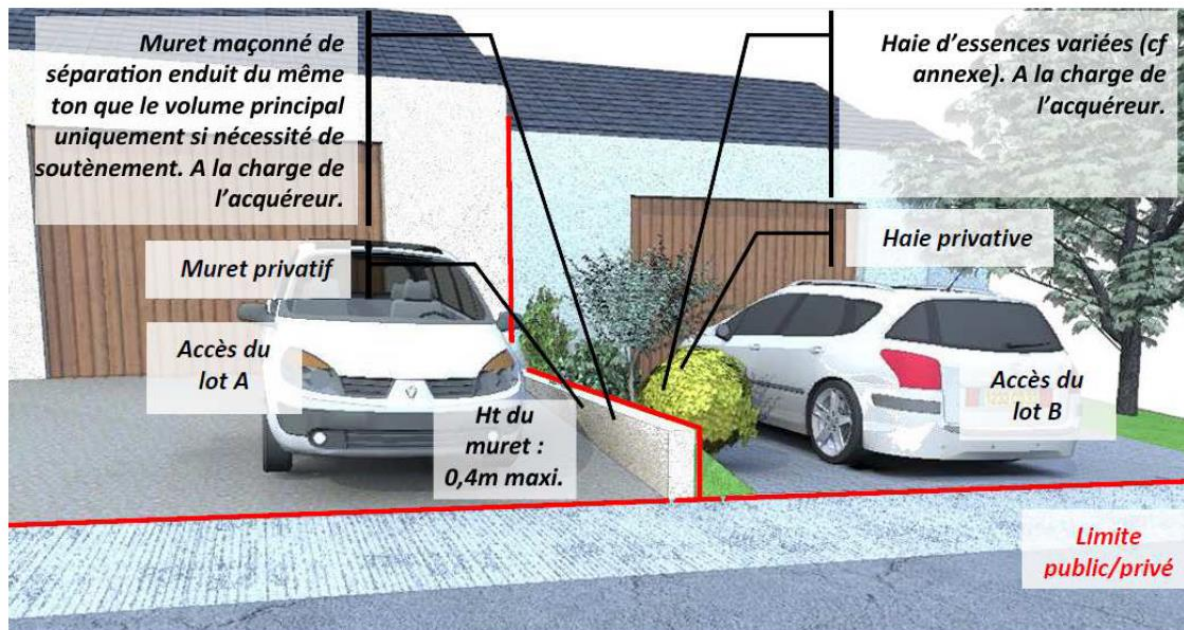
Principe d'un muret de soutènement en cas de différence de niveau
